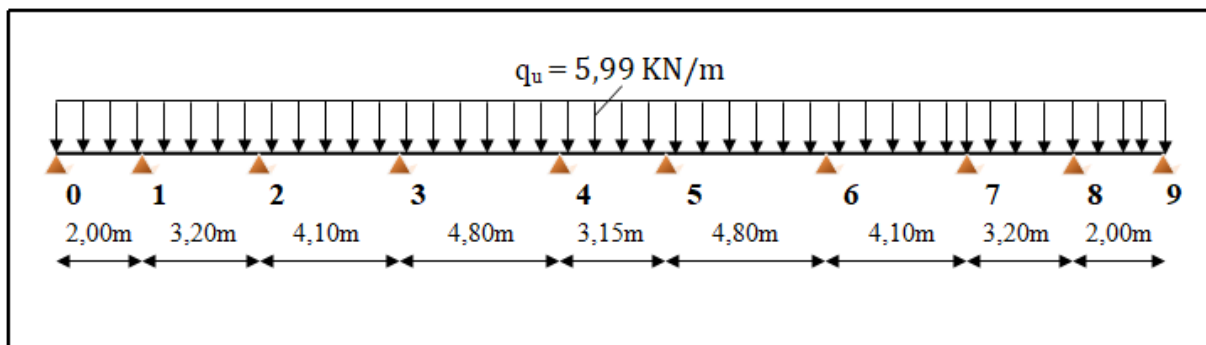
schéma statique des poutres à l'ELU (1^{er} cas).
